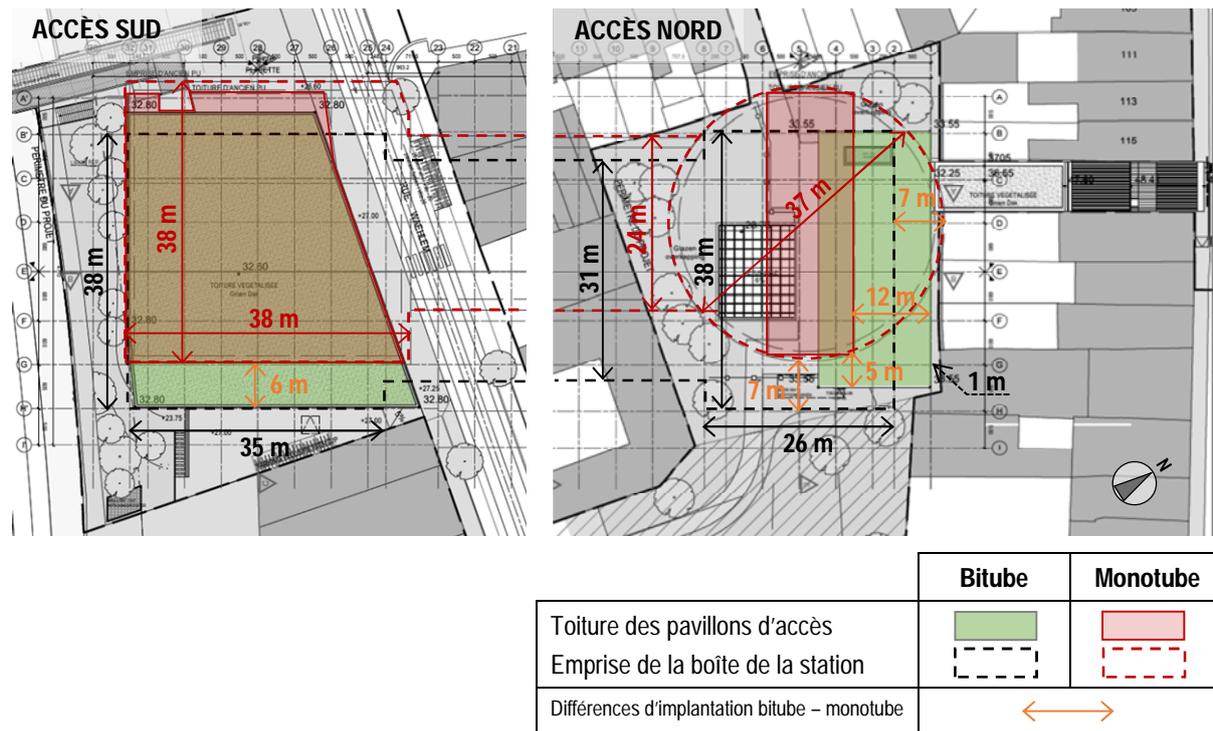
Implantation de la station Verboekhoven : plan du rez-de-chaussée (BMN, 2020)
